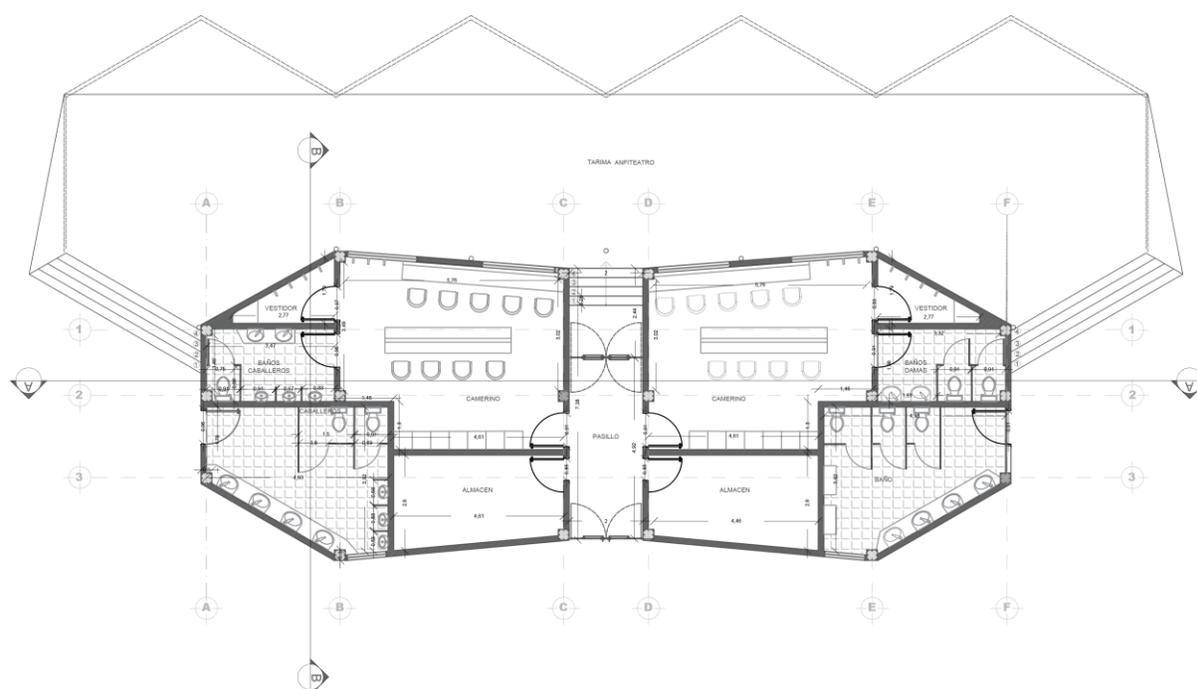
Planta arquitectónica servicios anfiteatro; Fuente: elaboración propia
